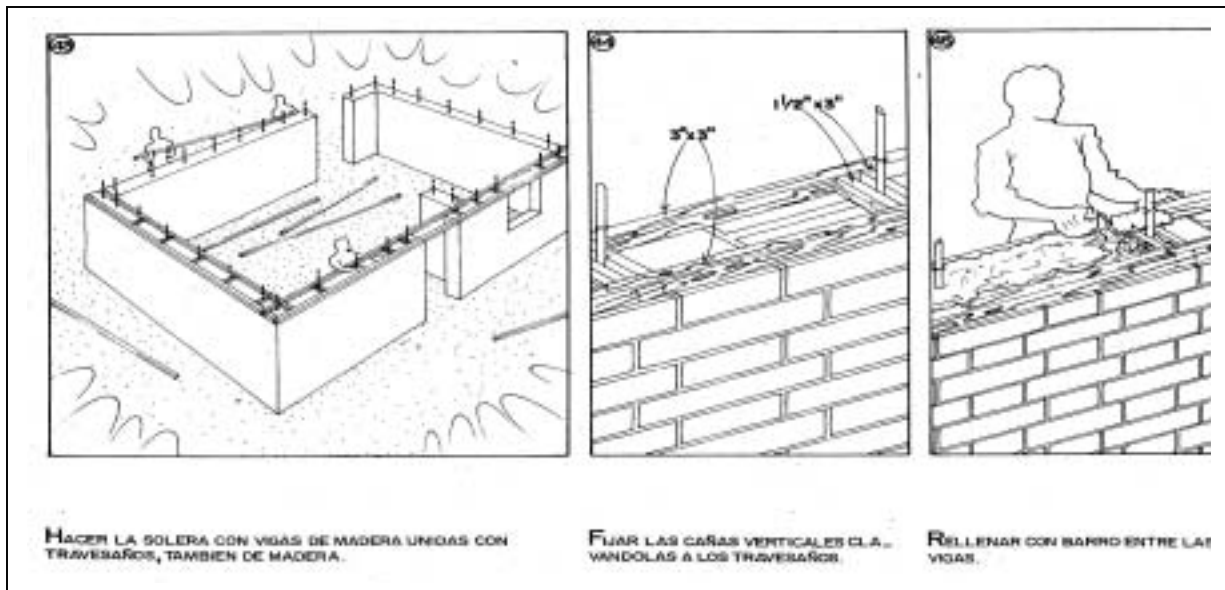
Guía para la Construcción de la Viga Collar de Madera (PUCP/CIID, 1995)
